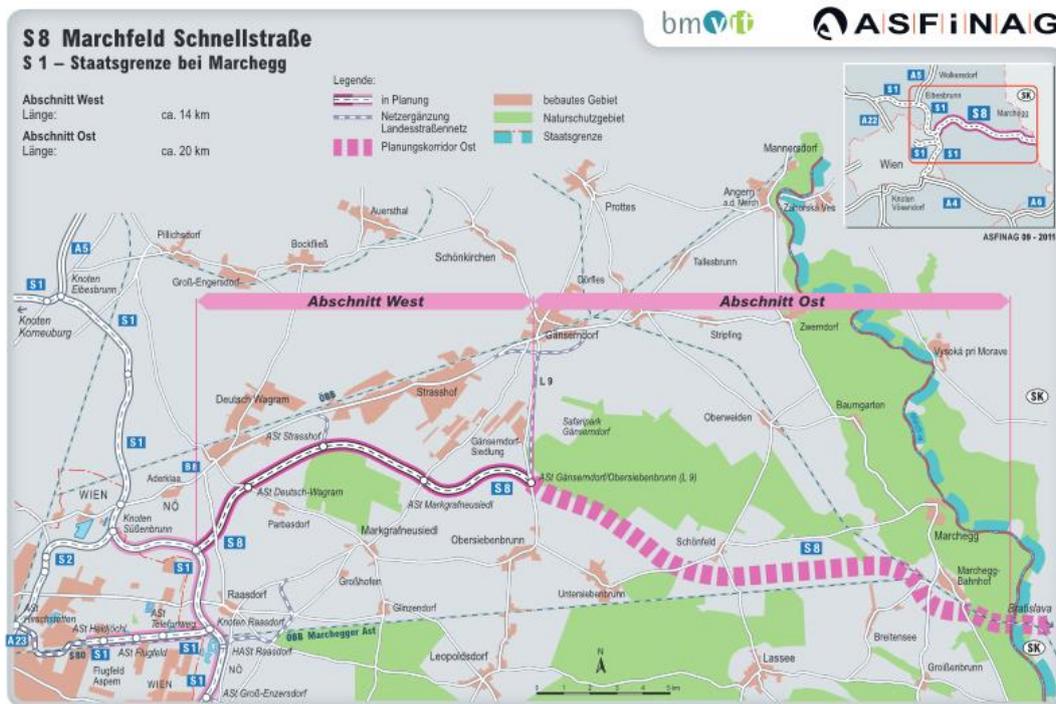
Lageplan der geplanten S8 Marchfeld Schnellstraße⁴
